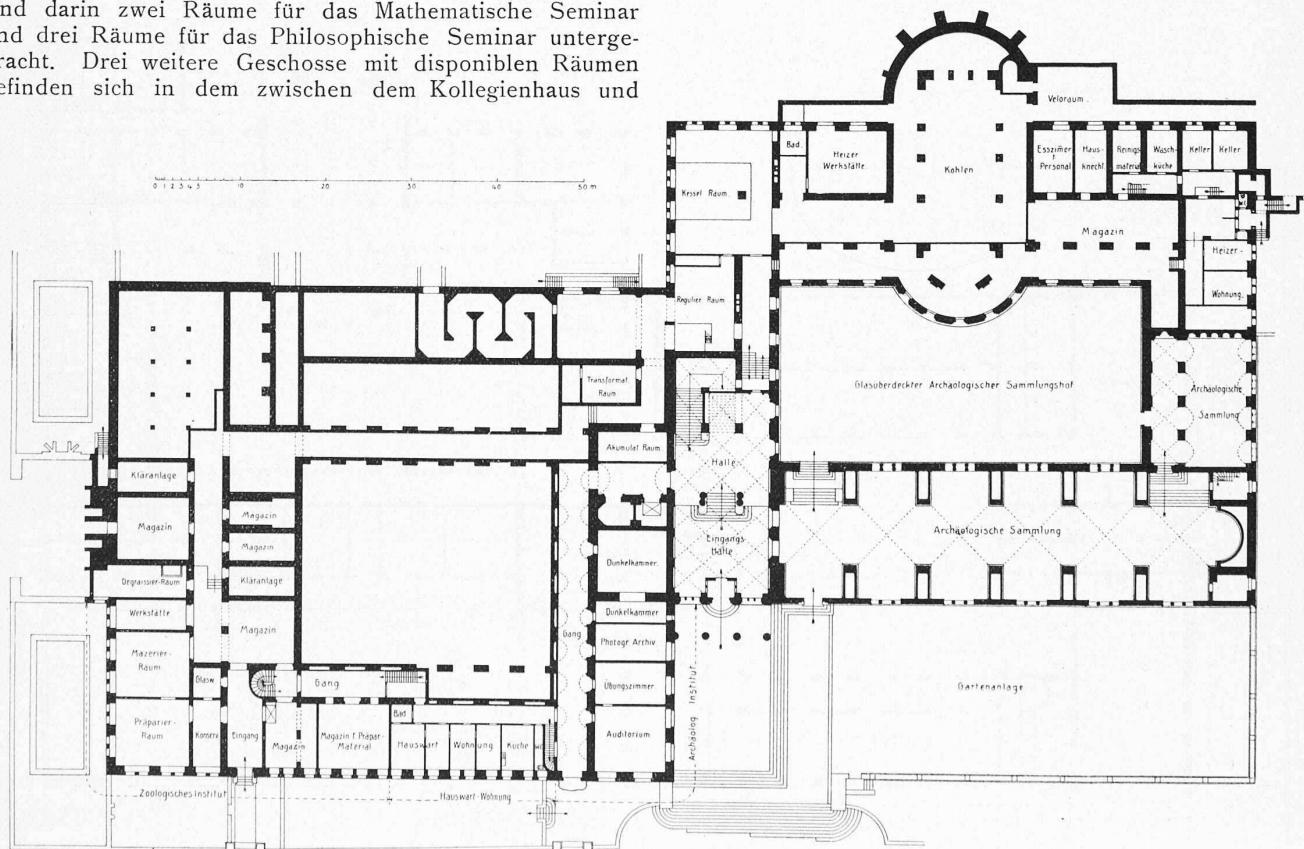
Grundriss vom Untergeschoss. — Maßstab 1:800.
